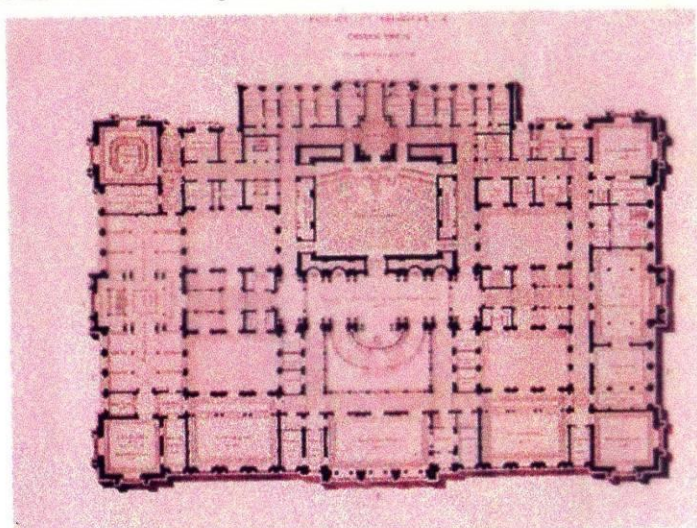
Plan du bâtiment Reichstag, de l'architecte Paul Wallot (Redecke, 7)
